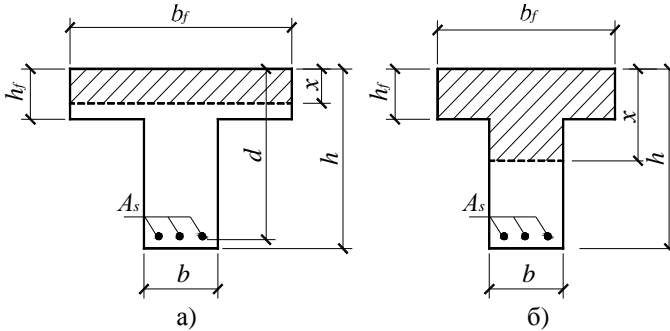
Випадки розташування нейтральної лінії у тавровому перерізі: а - у межах полиці; б - у ребрі
